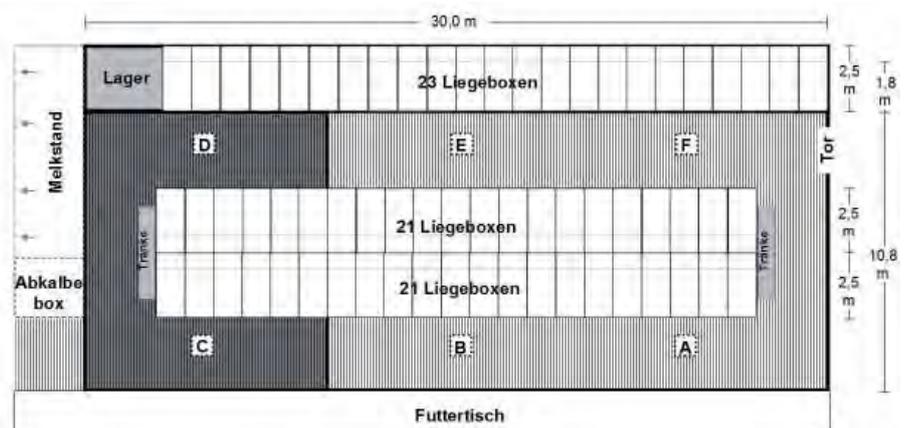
Stallgrundriss des Versuchsstalls mit Beprobungspunkten (A-F). Die dunkel schraffierte Fläche stellt die nicht gereinigte Kontrollfläche dar.
